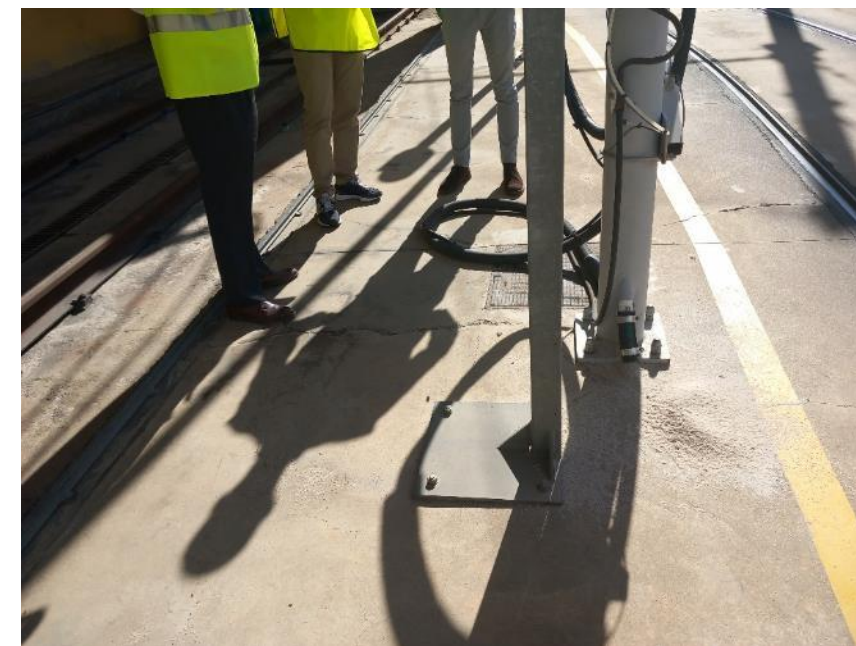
Zona exterior futuro acceso a nueva playa de vías aparcamiento exterior. Vista sureste
